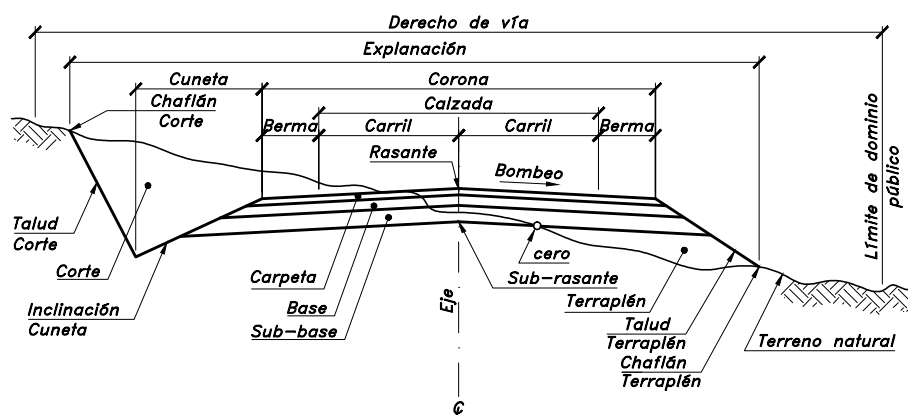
Sección transversal típica mixta, pavimentada en recta
